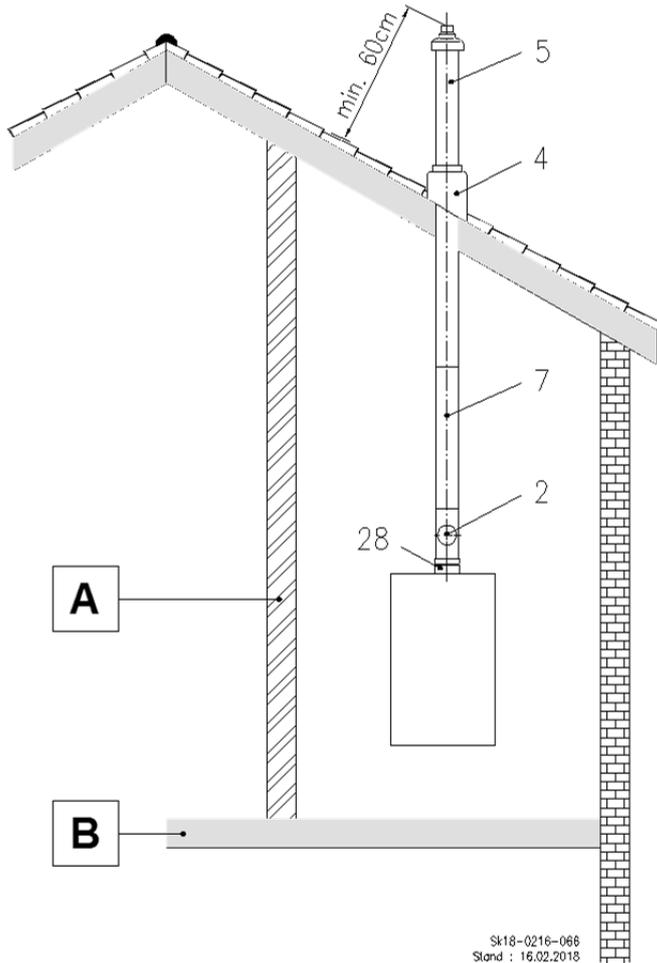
C<sub>33X</sub> Dachheizzentrale mit der Durchführung senkrecht durch ein Schrägdach
